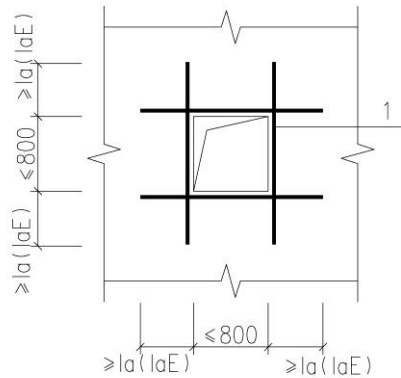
预制剪力墙洞口补强钢筋配置示意
